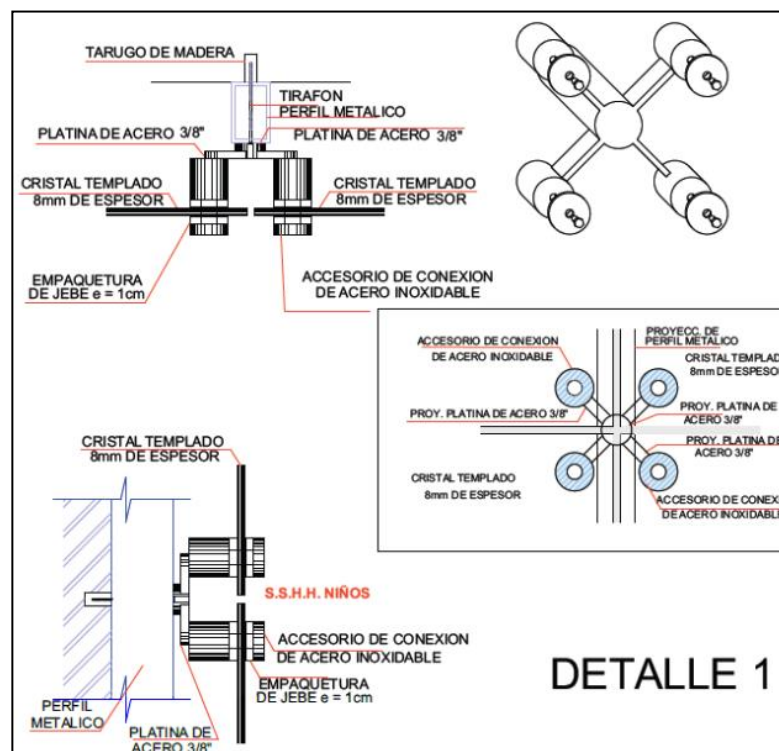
Detalle Sistema Spider de Muro Cortina Fuente: Elaboración Propia
